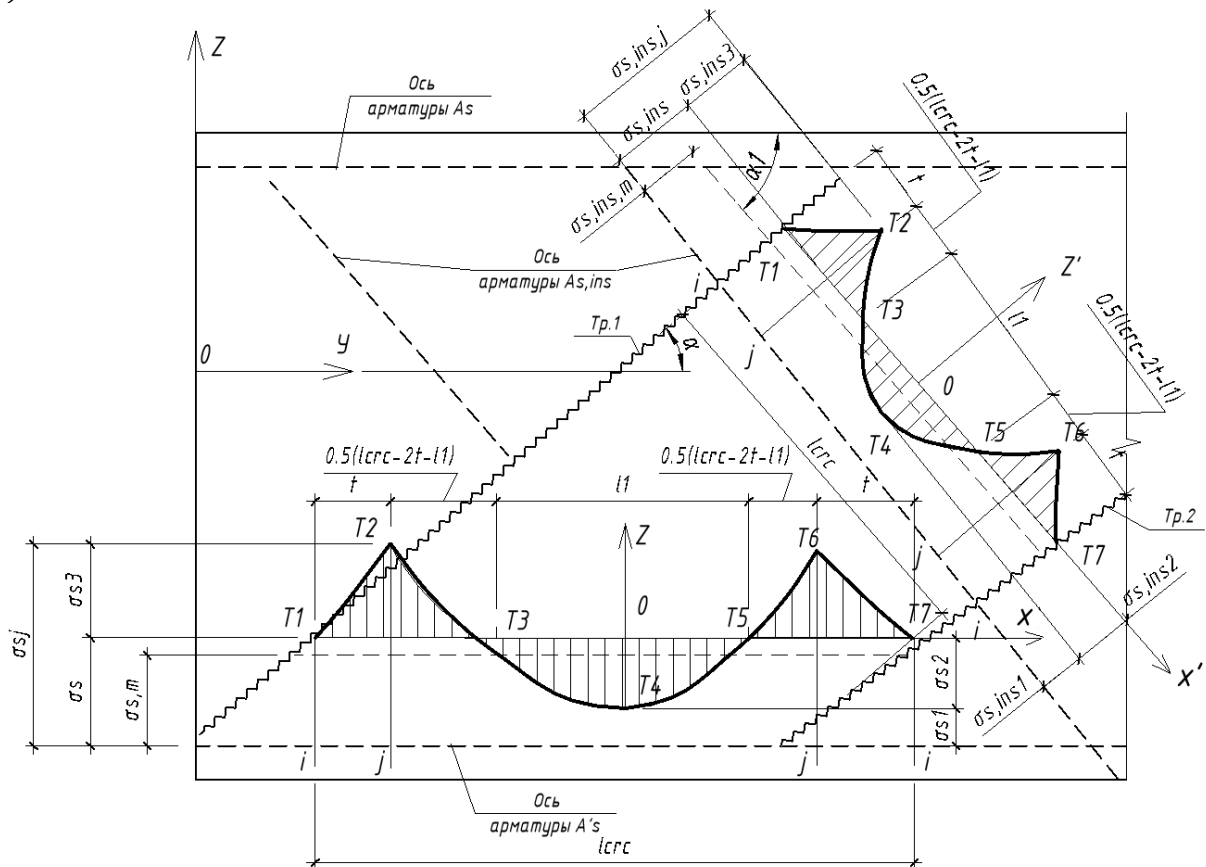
Характерные опытные эпюры напряжений в продольных и наклонных арматурных стержнях и бетоне на участках между смежными трещинами
